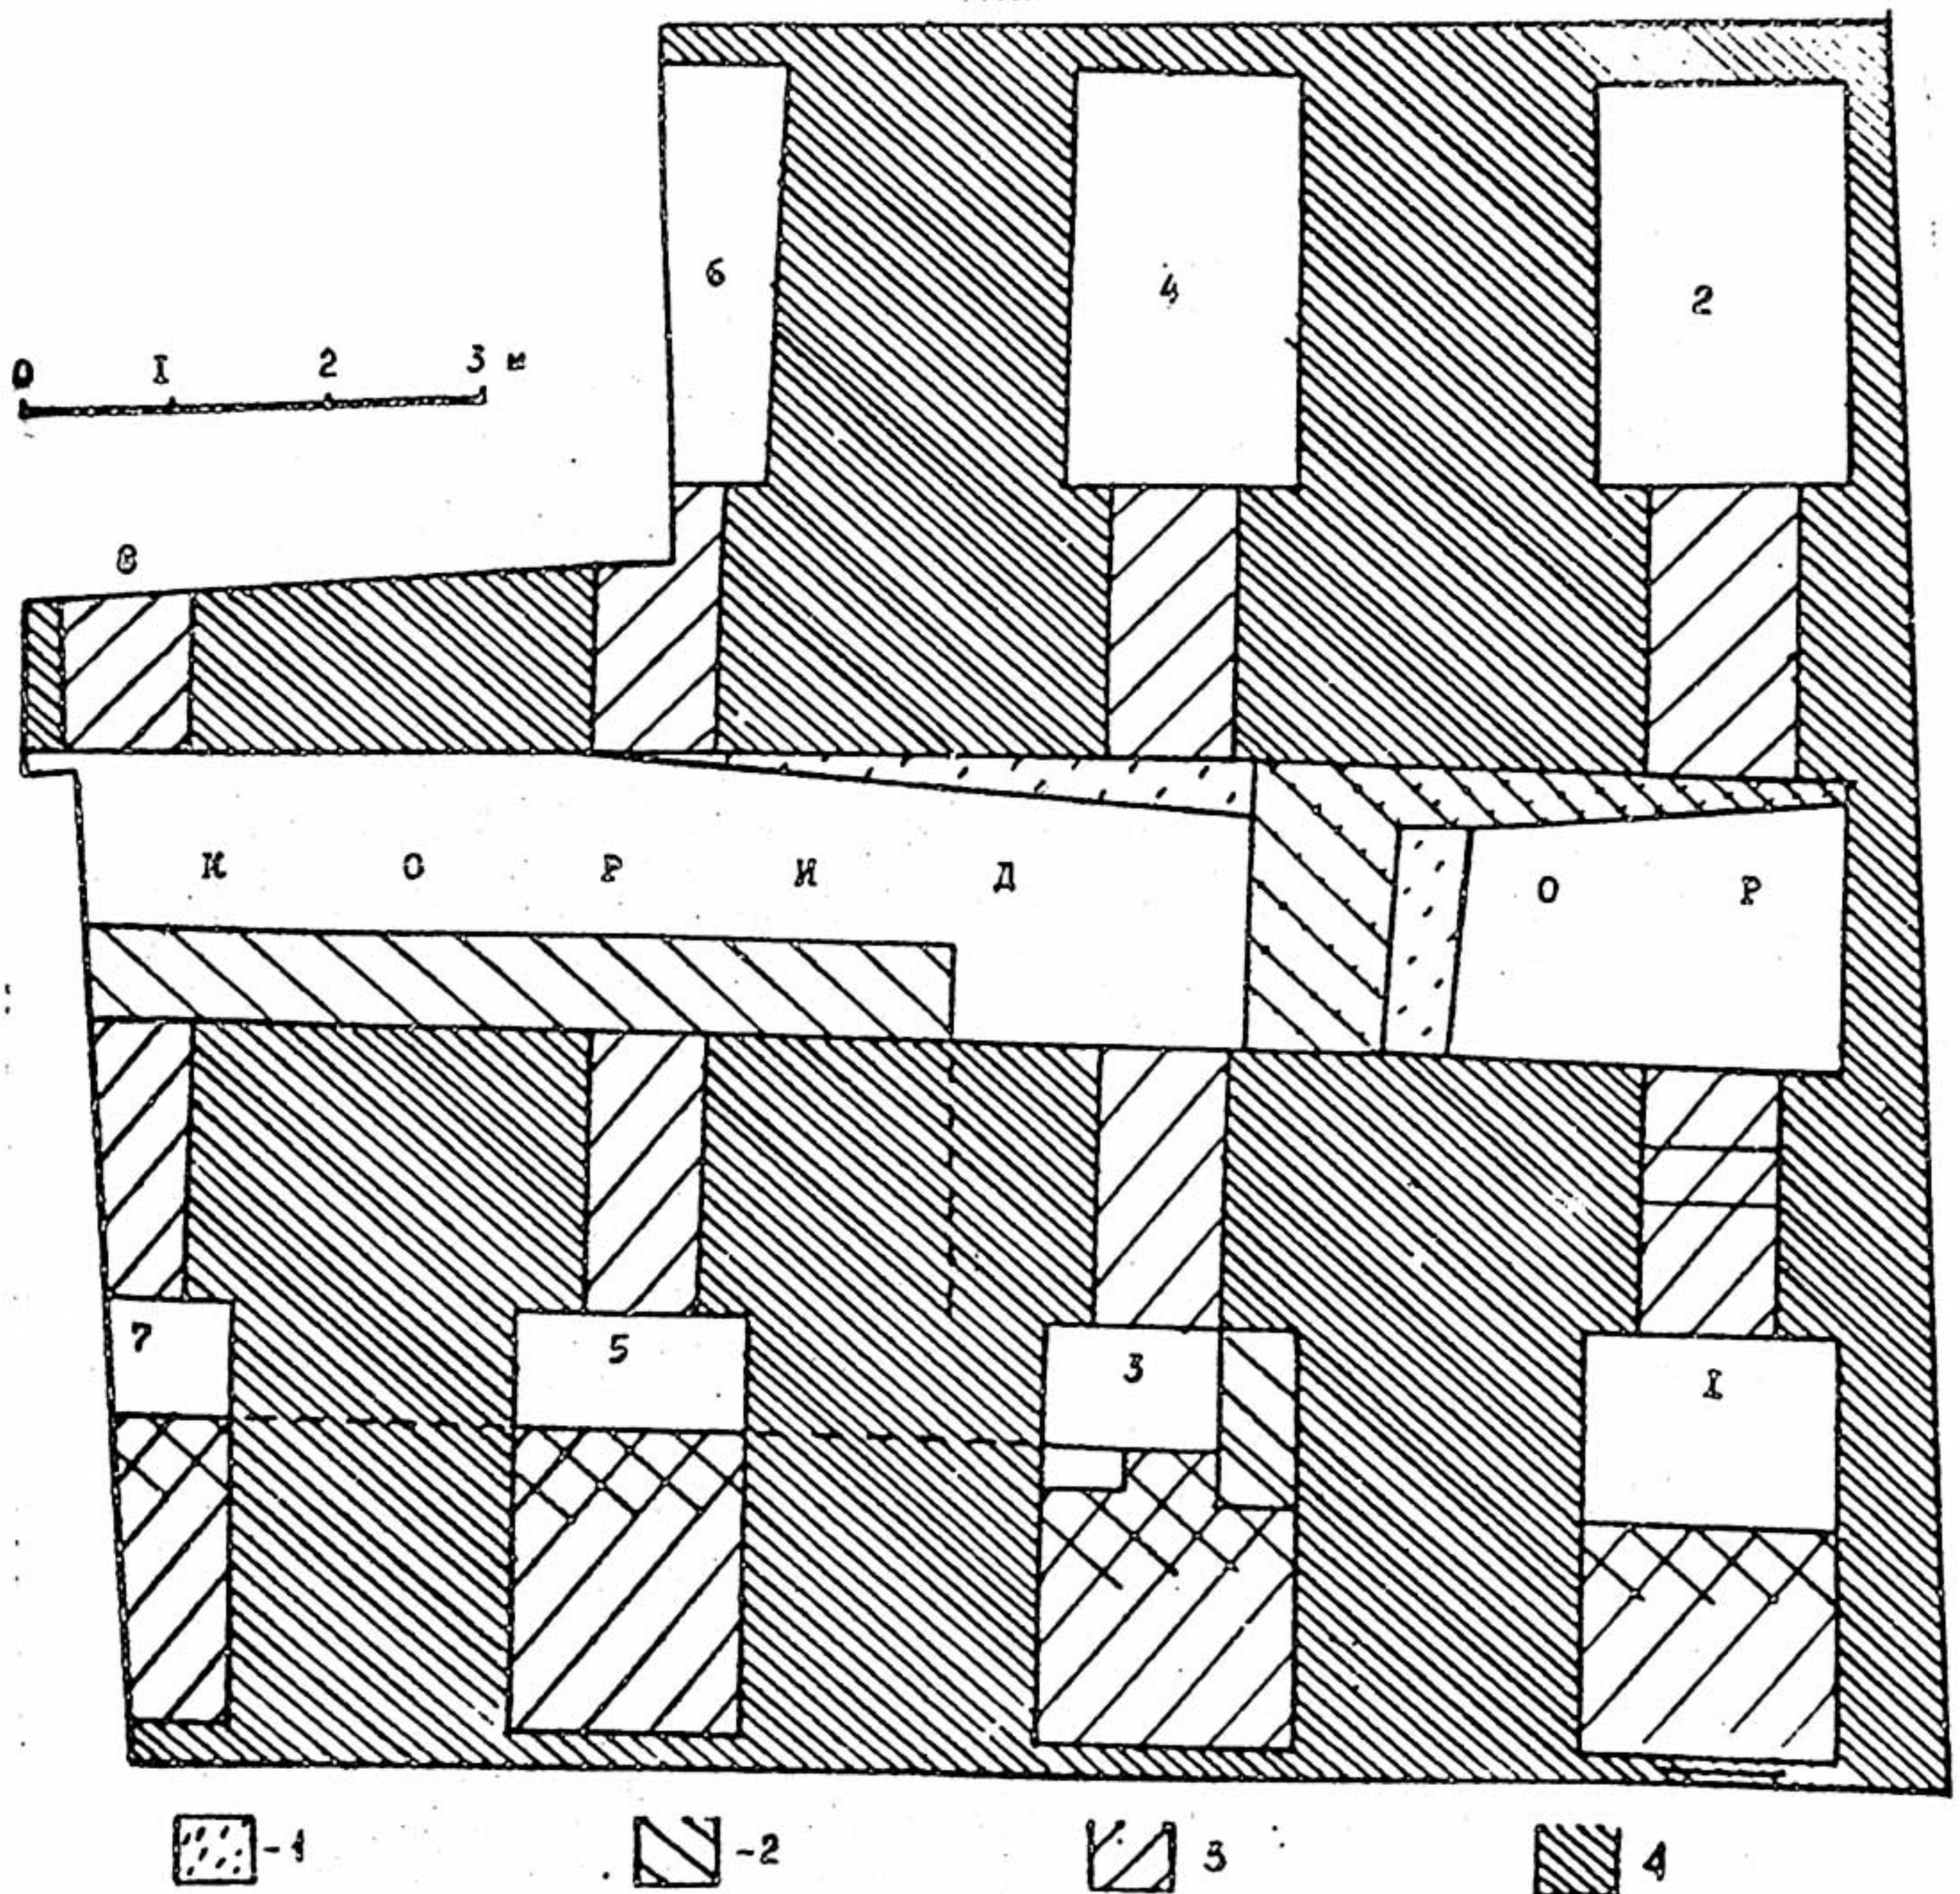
Кахрамонтепе. План здания IV строительного периода и остатки более ранних стен.
